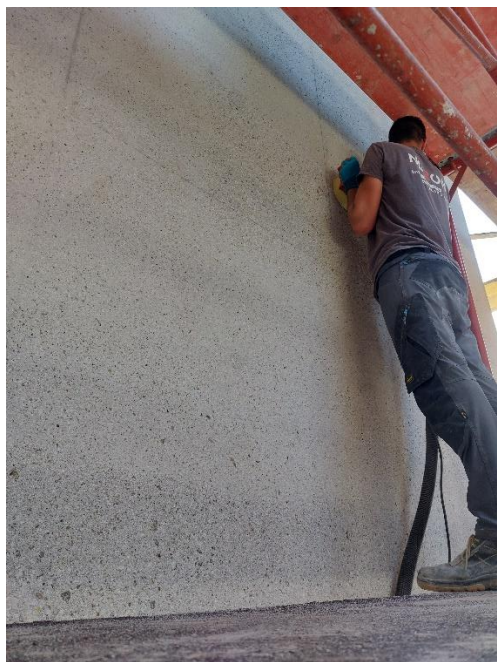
Prikaz različnih struktur betona na delovnem stiku po brušenju in štokanju
